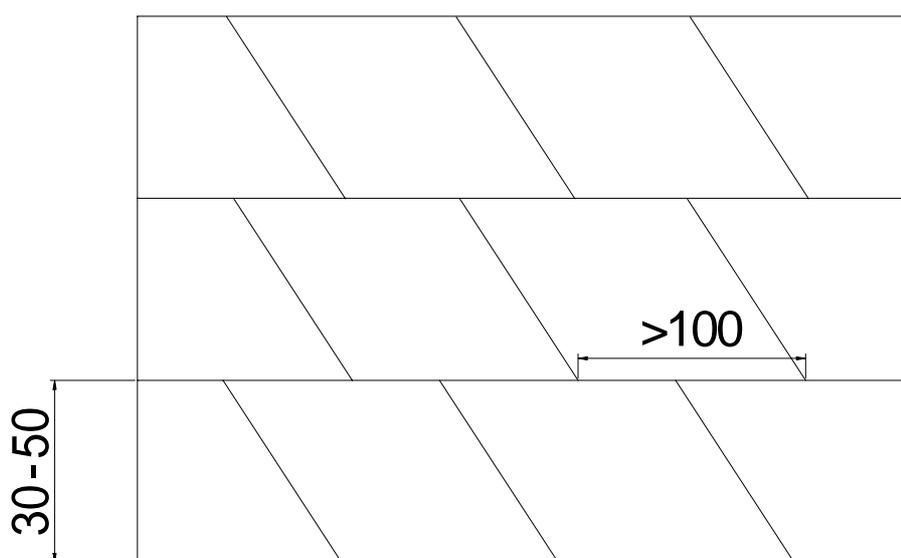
混凝土分块分层台阶法浇筑示意图
